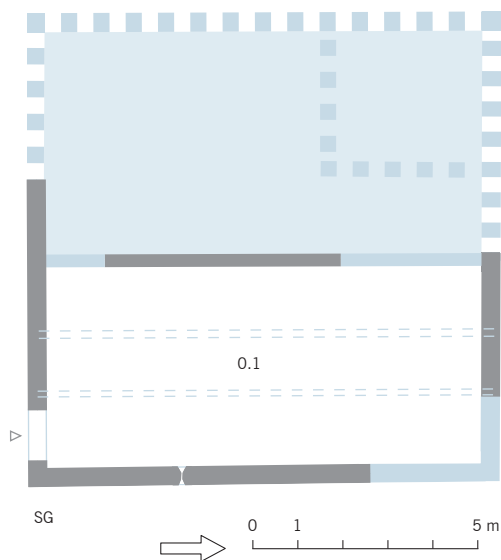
Haus Chammersbüel in Unterägeri, Grundriss des Sockelgeschosses.
